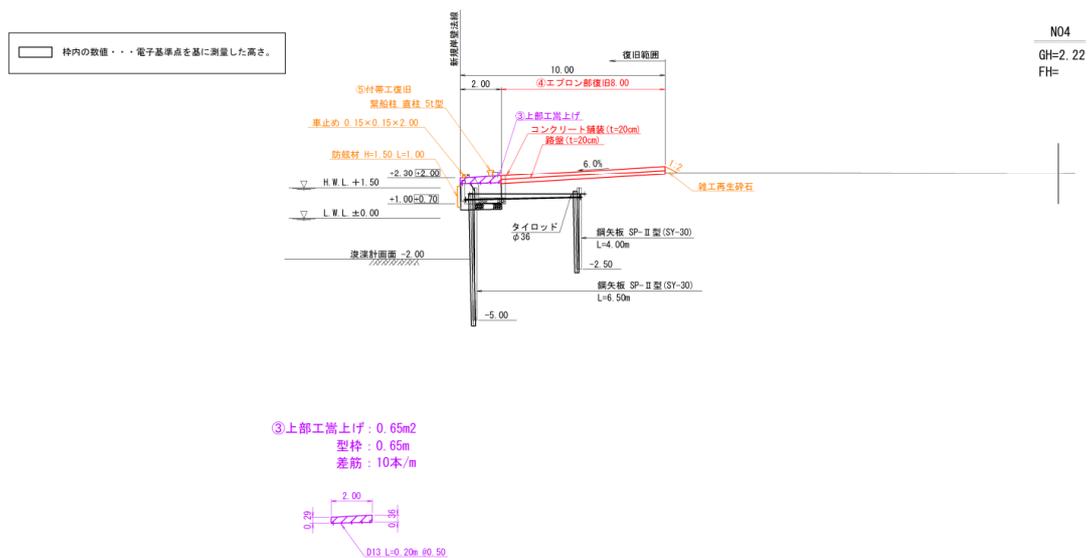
No.15 日立港区_第5埠頭地区第2船だまりの東1断面図 (復旧後)
